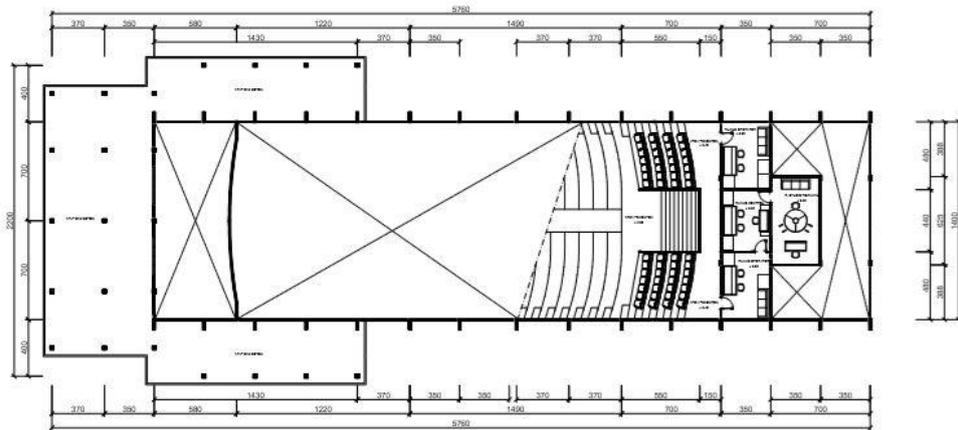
zoning dan sirkulasi alternatif 2 lantai 2
